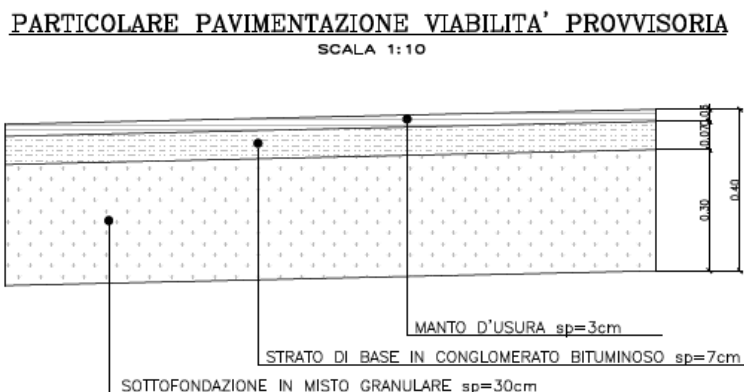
Particolare pacchetto di pavimentazione viabilità provvisoria
